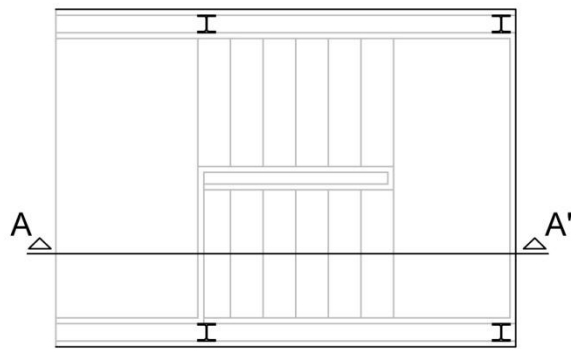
Núcleo escalera exterior subida a planta 1. Fuente: Propia autora.
